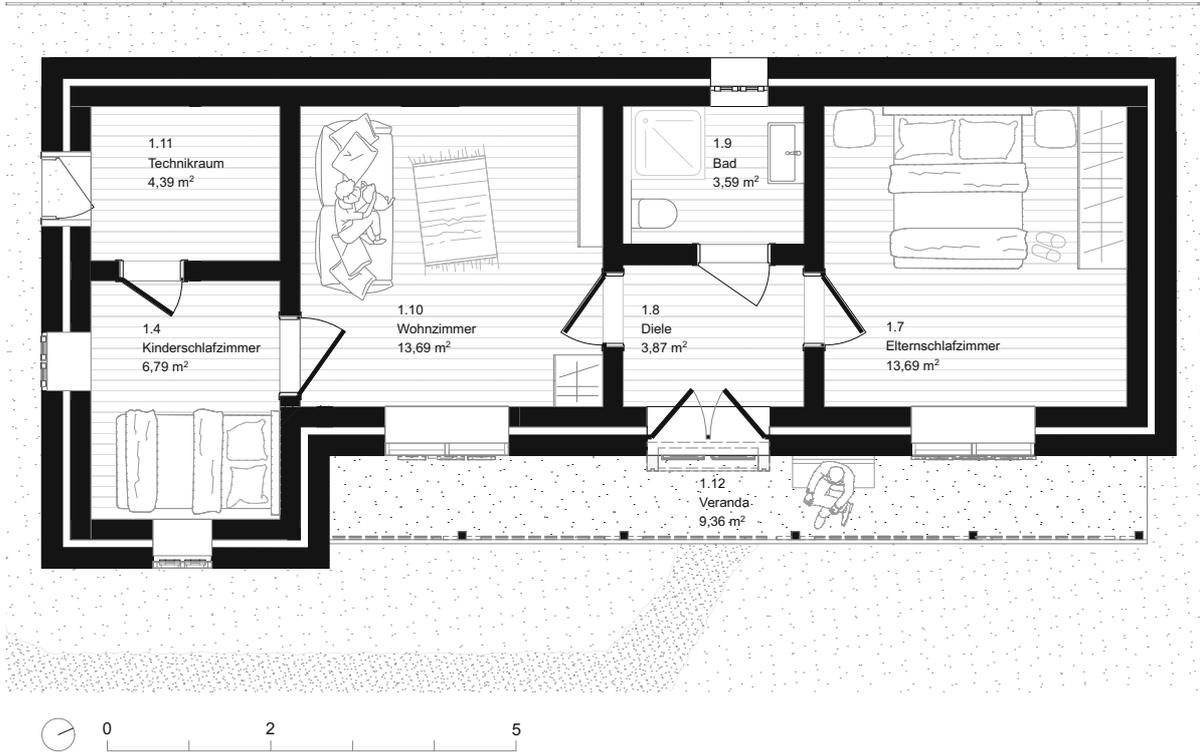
Wohnhaus, Grundriss Neugestaltung
